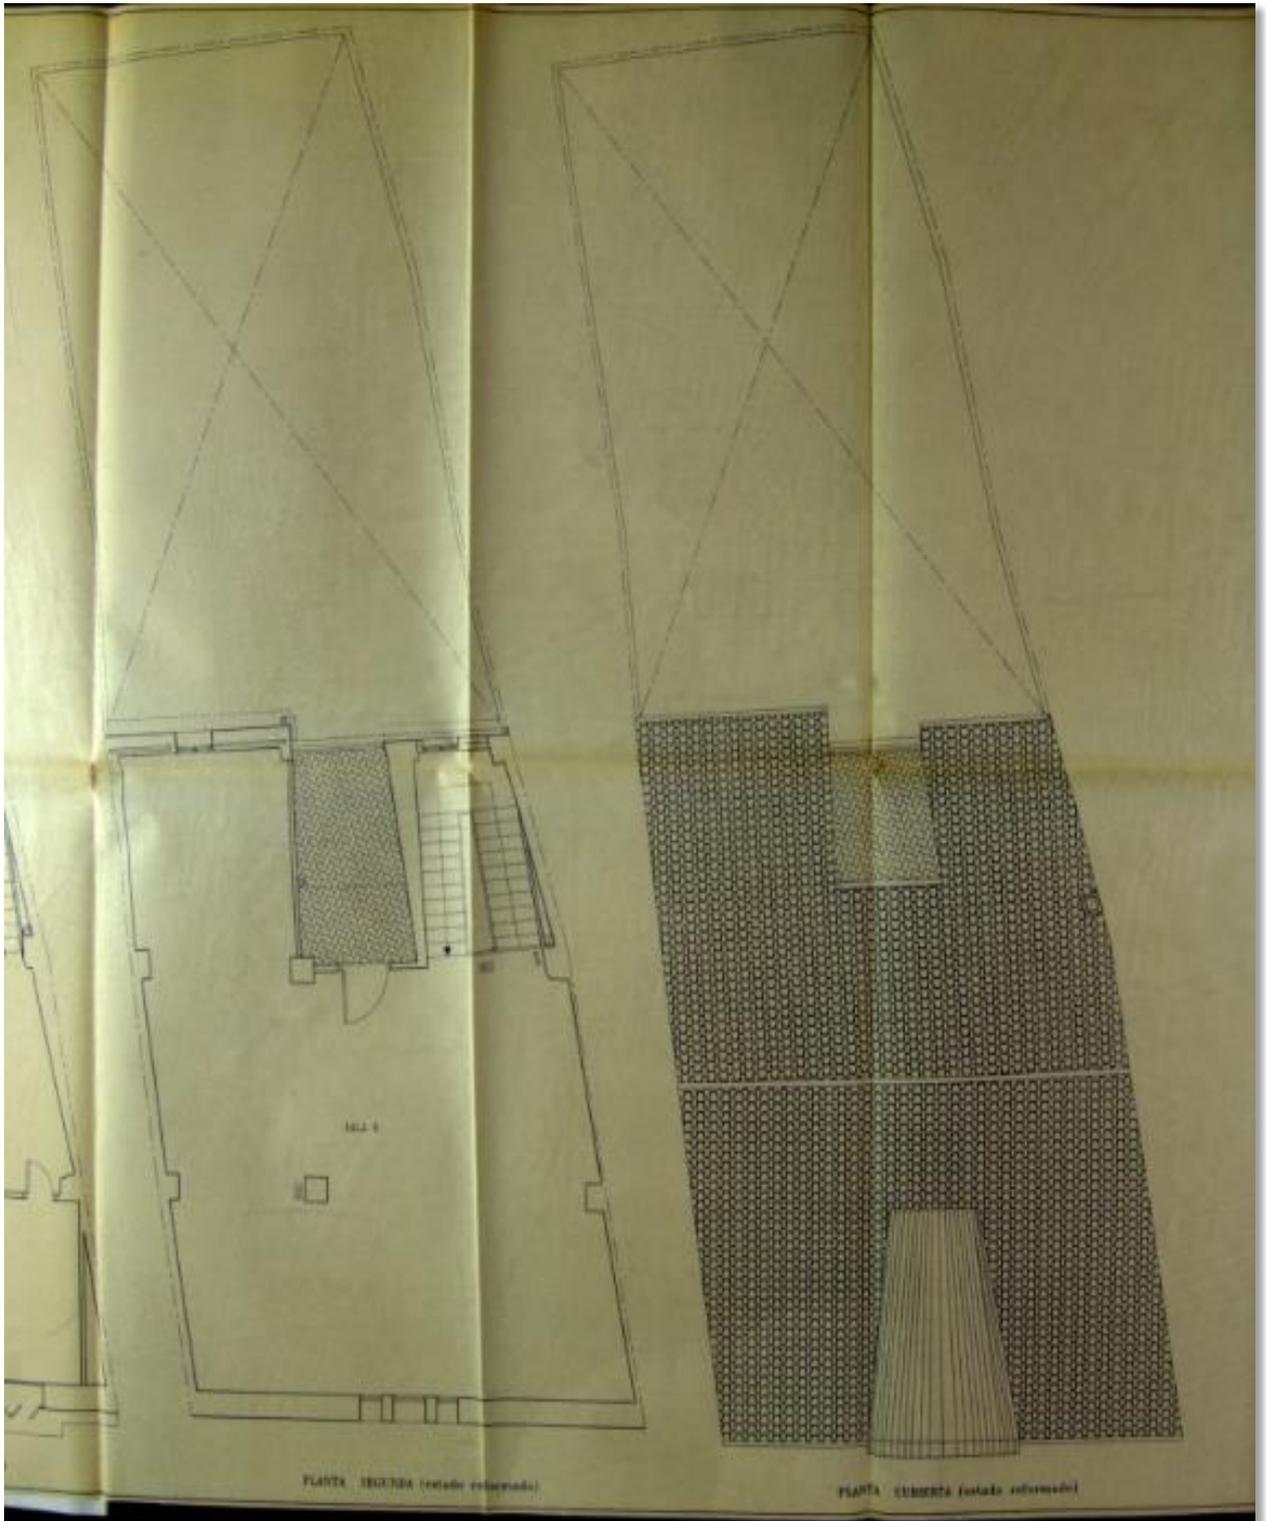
Plano de planta segunda y planta cubierta. Reforma 1948.
